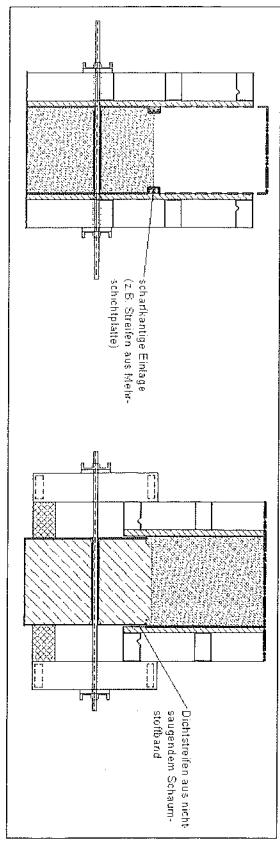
Flächenbündige Arbeitsfuge; links: erster Betonierabschnitt; rechts: zweiter Betonierabschnitt
